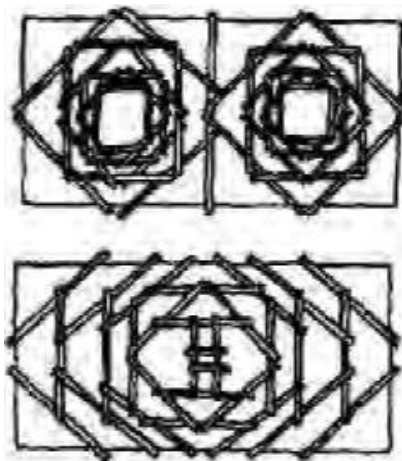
Реконструкция перекрытия Е.Е. Кузьминой [36, с. 405]
